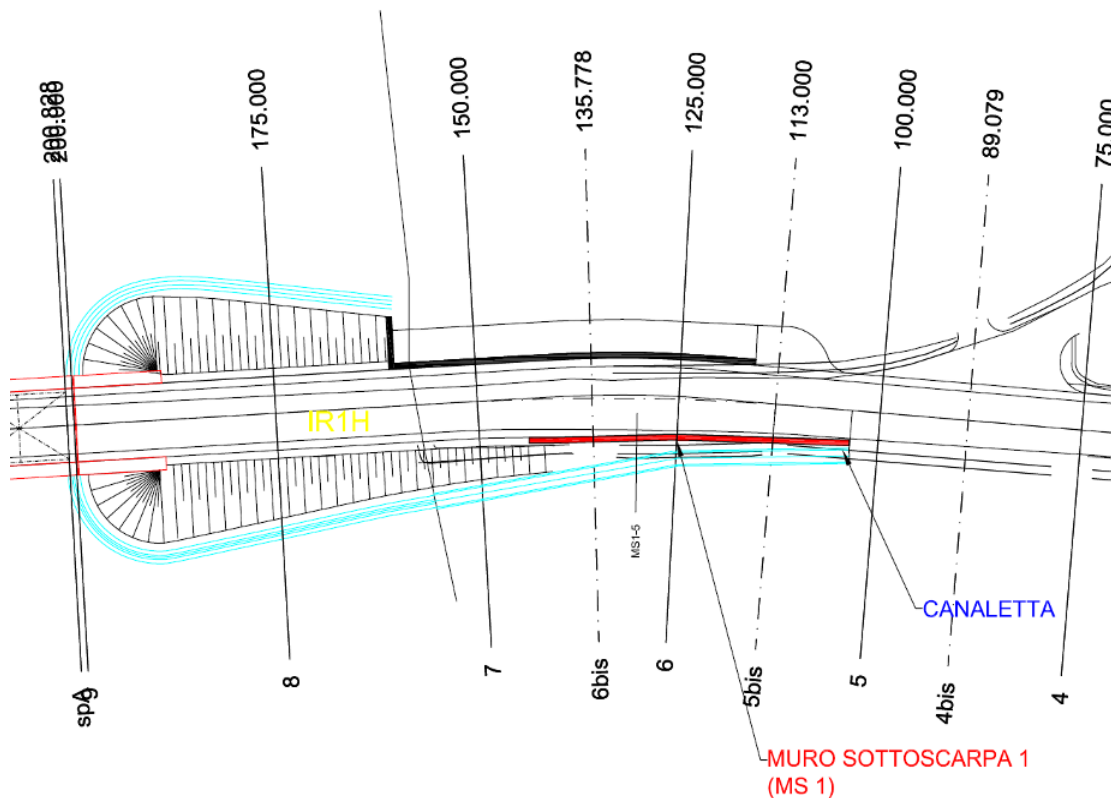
Ubicazione planimetrica del muro di sottoscarpa.
